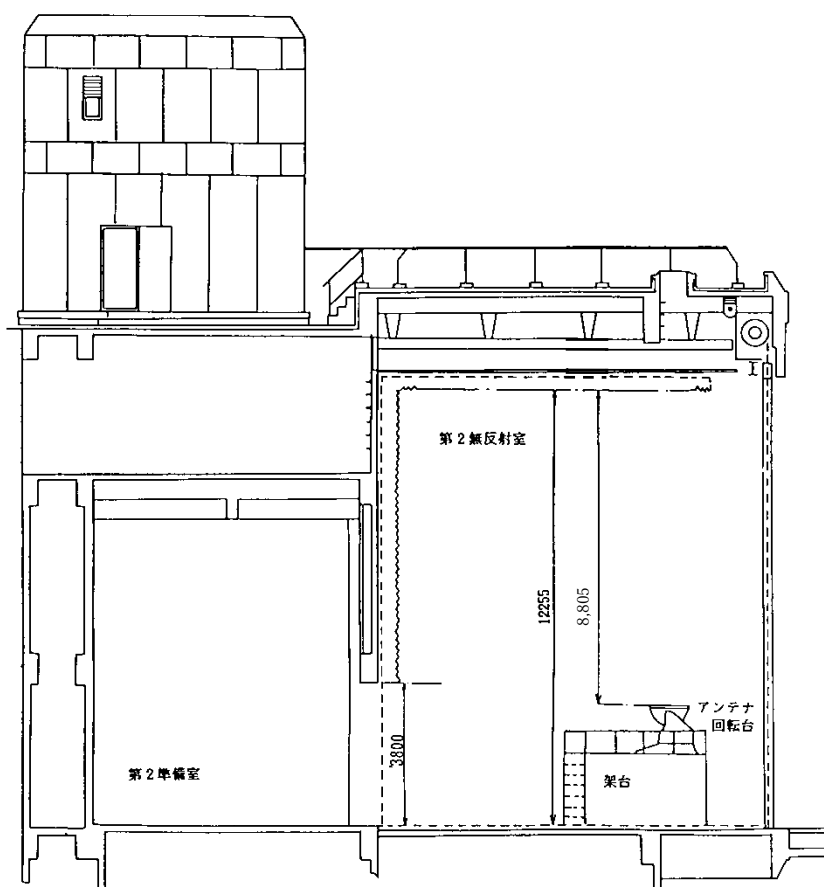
第二無反射室及び第二準備室等の配置図（断面図）
